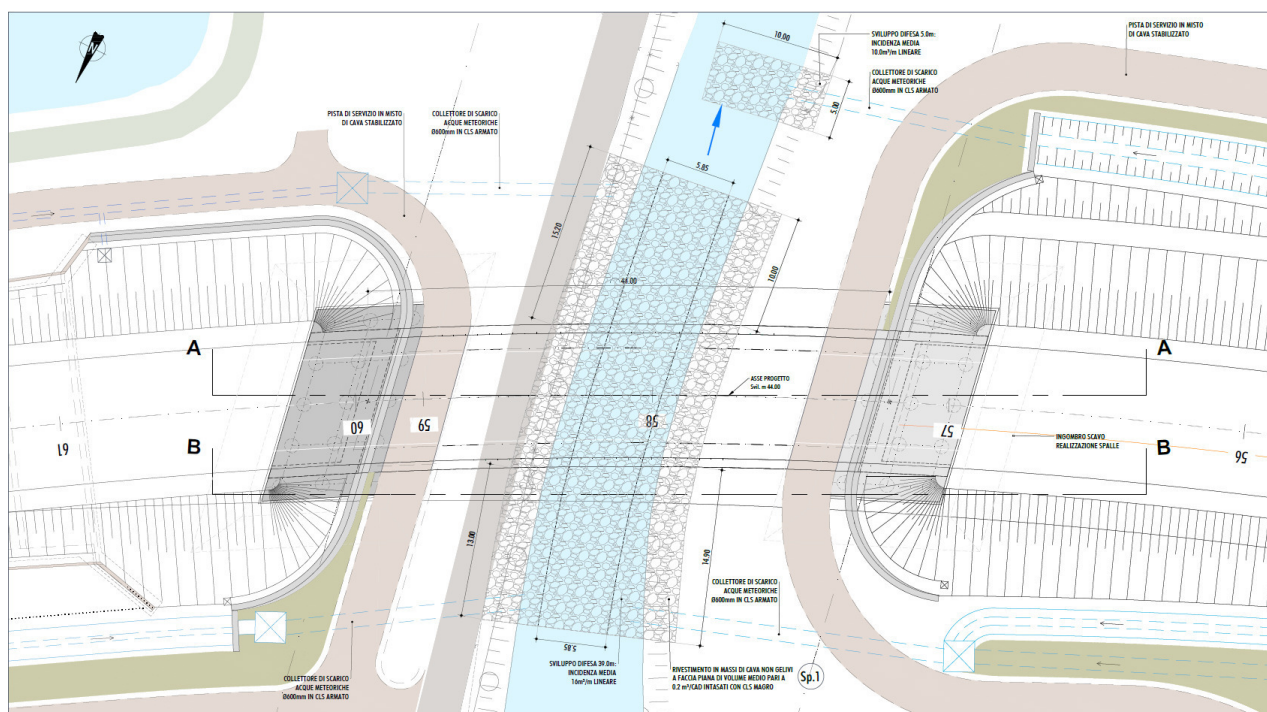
ROGGIA ZUBANA: PLANIMETRIA NELL'INTERNO DEL PONTE DI PROGETTO
